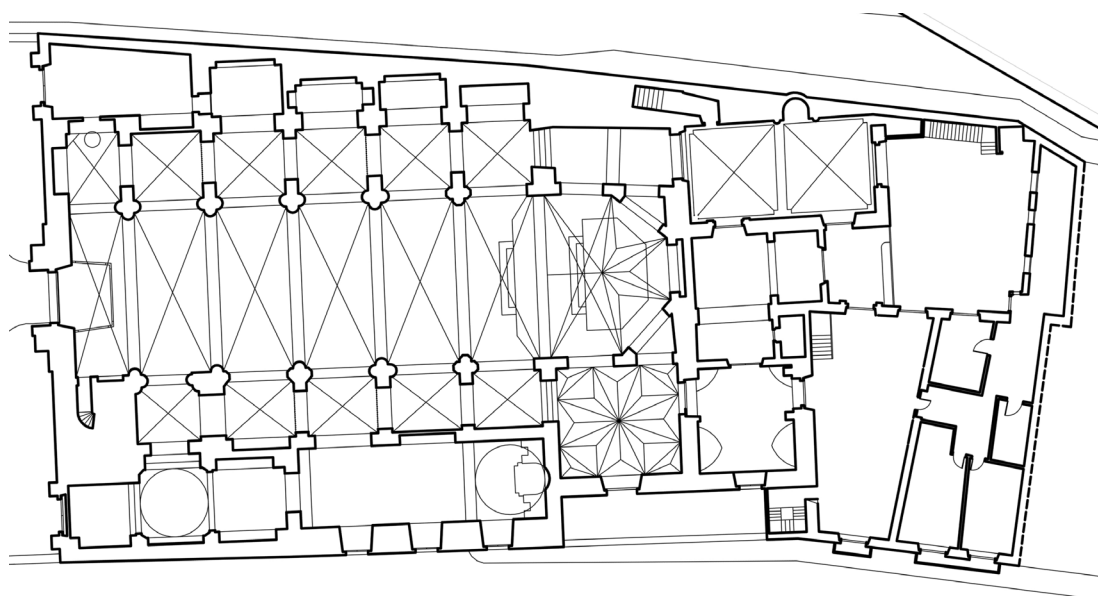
Planta actual de la iglesia de Santa María de Alicante. Autor: M. Bevià.
